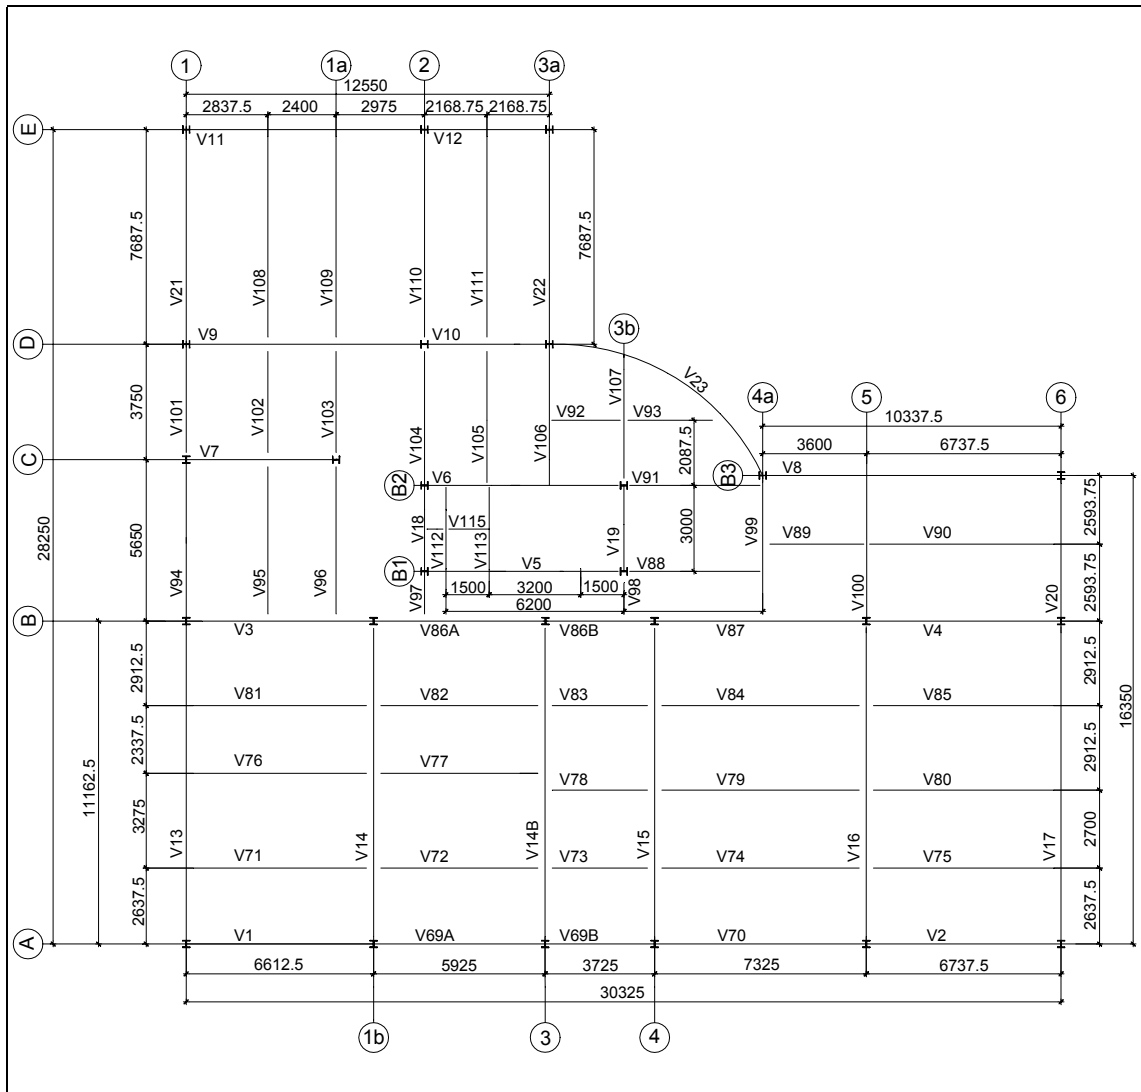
Vigamento do Pavimento 1 do Edifício 3 – EL. 3000 mm.
